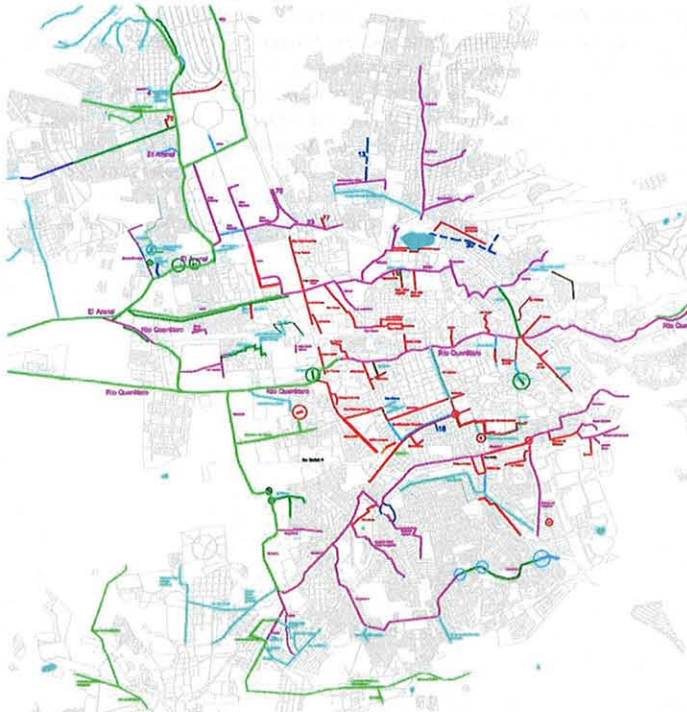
Red de drenaje pluvial existente hasta el año 2008.
